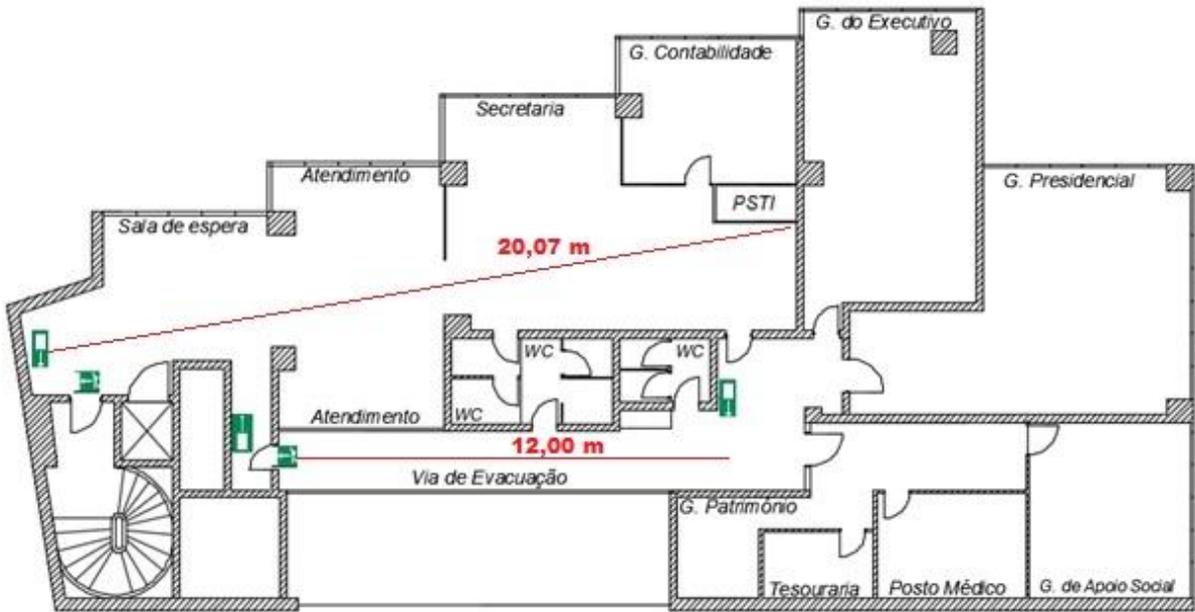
Planta do 1º Piso - Sinalizações de emergência e maiores distâncias de avistamento
